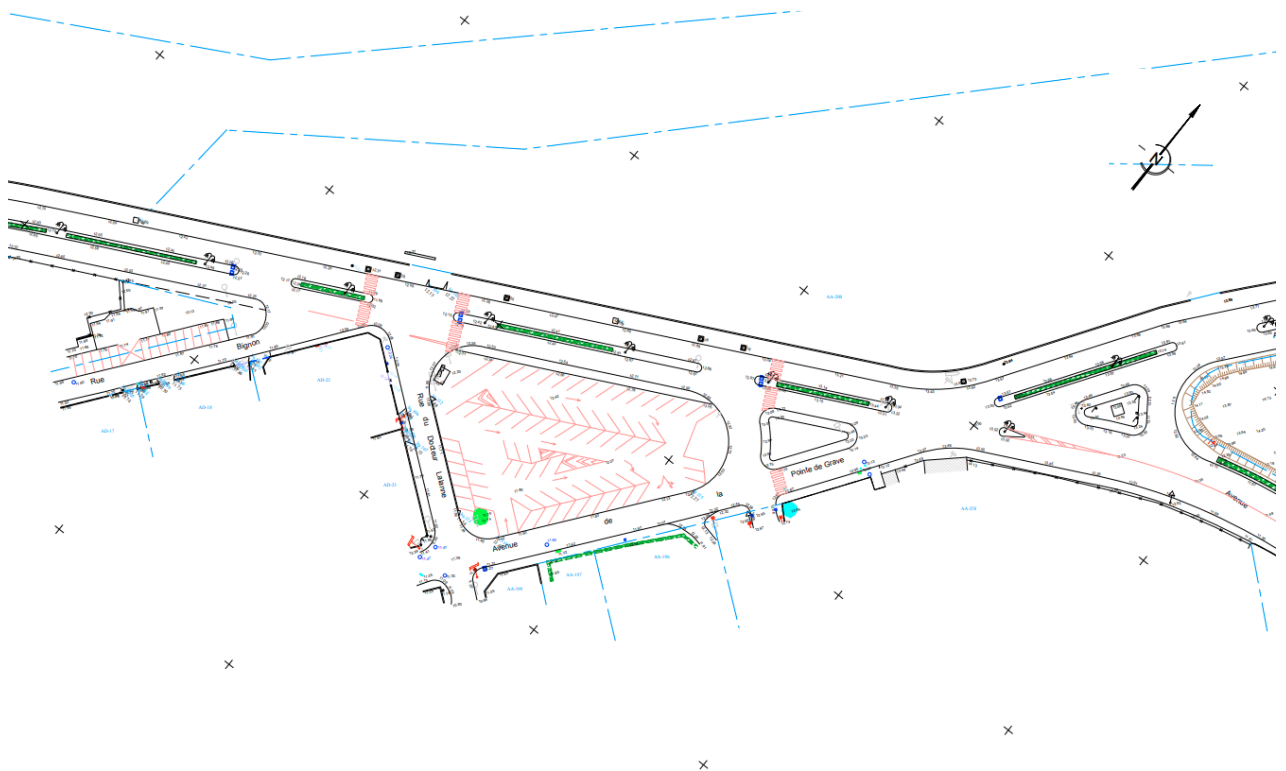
Plans de l'existant avant travaux (portion 4) (Source : PRO –juin 2018)
